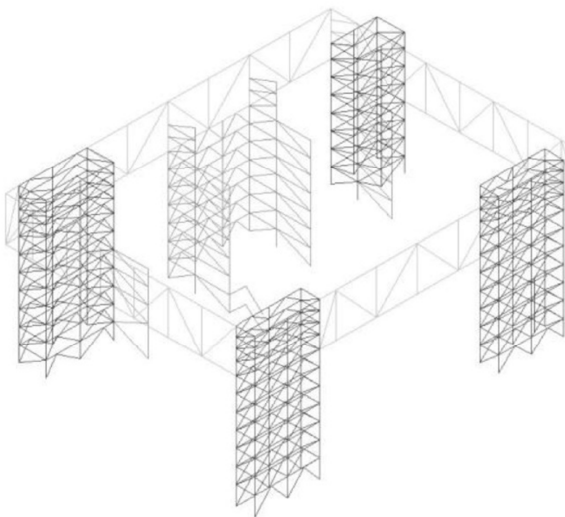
Macroestructura. Pórticos rígidos (núcleos de hormigón / celosías metálicas) en ambas direcciones.
